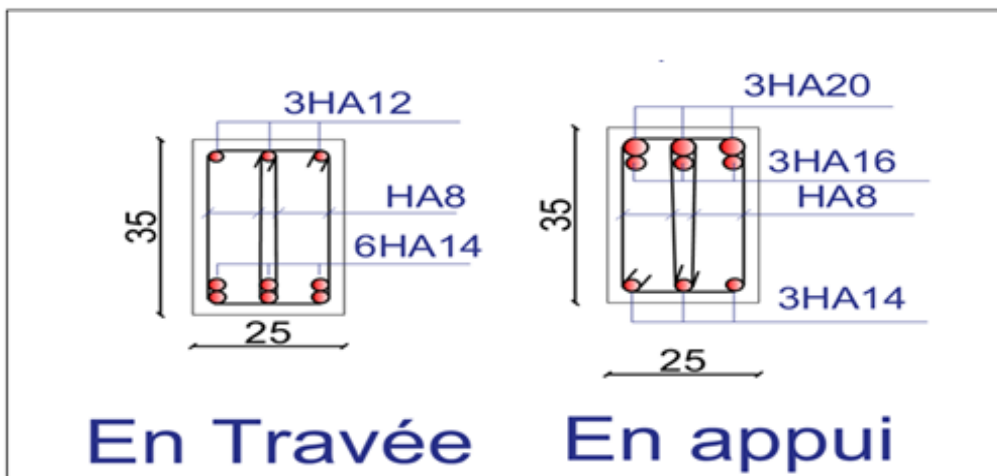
schéma de ferrailage des poutres secondaires liée au voile
